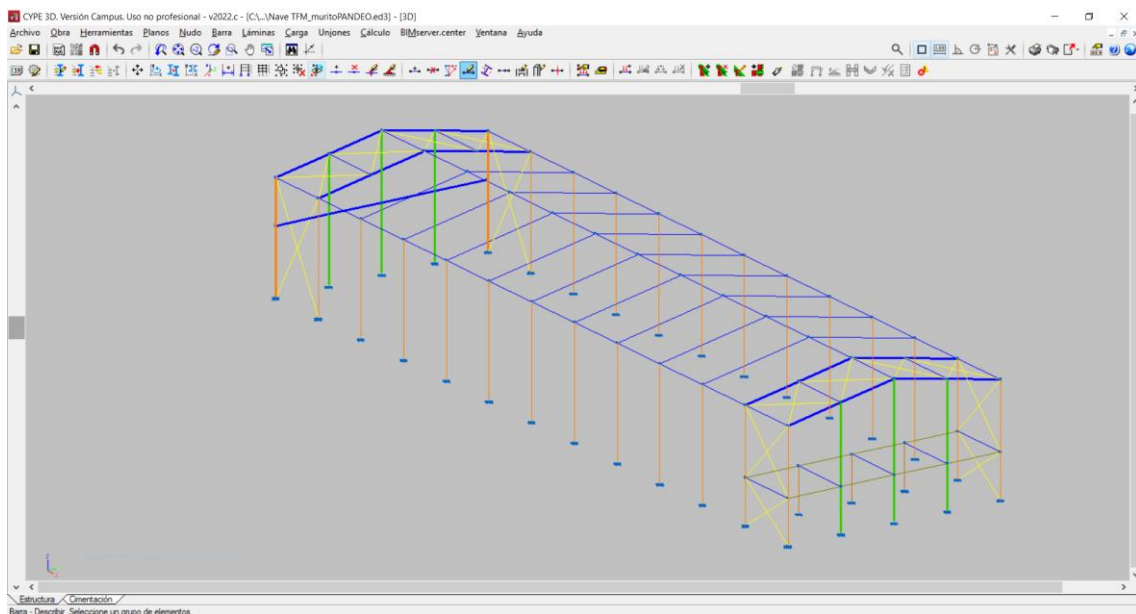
12 Barras de grupo 1 – Pilares indicados en naranja
